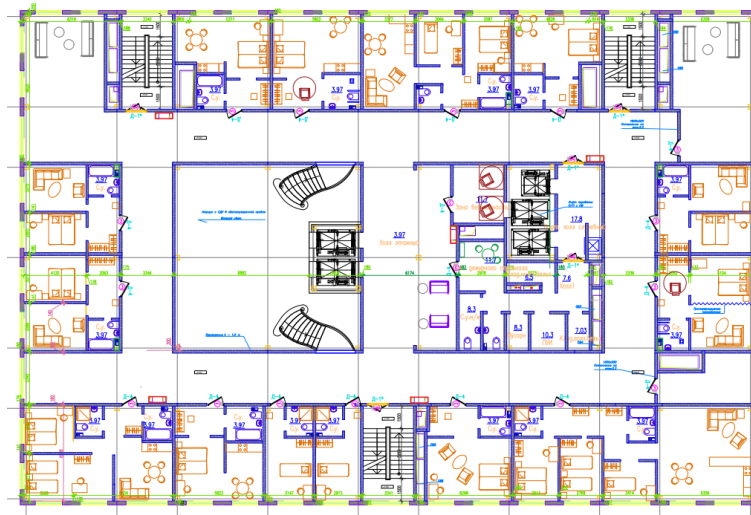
План типового этажа гостиницы, размеры 32м на 48м
